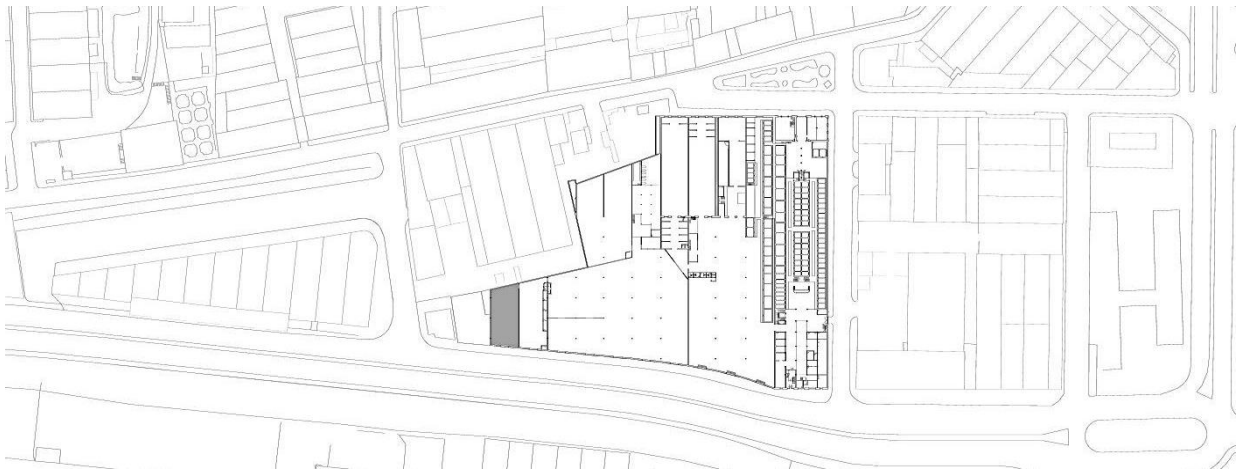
Planta de levantamento fotográfico piso térreo – Armazéns 20.
